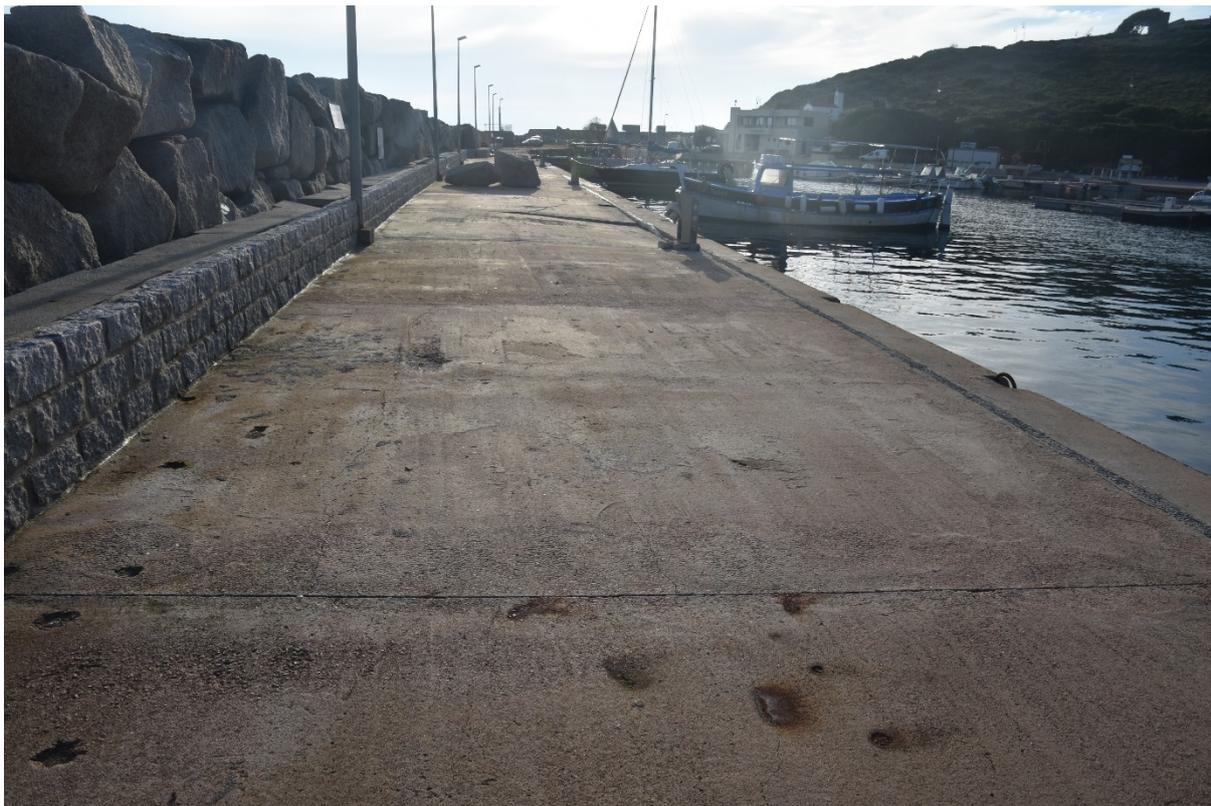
Structures D4 et D4 bis : digue en enrochements, dalles, poutre de couronnement
